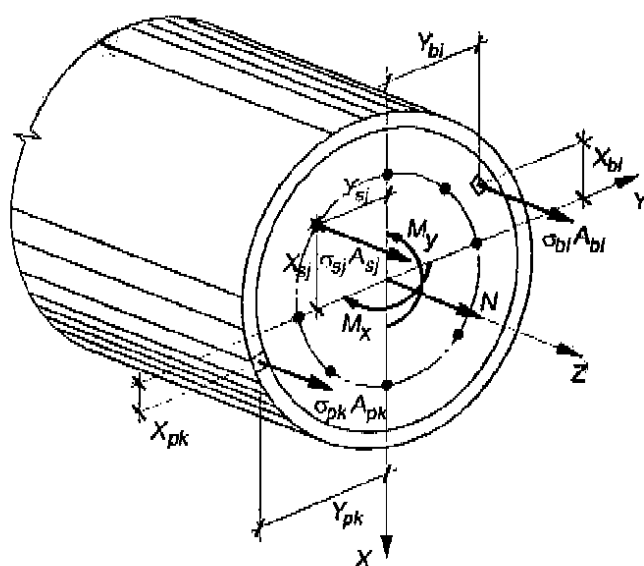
Расчетная схема нормального сечения трубобетонного элемента
